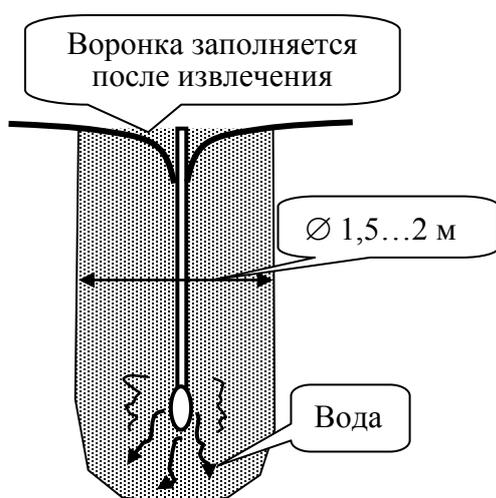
Схема глубинного гидровиброуплотнения сыпучего грунта
